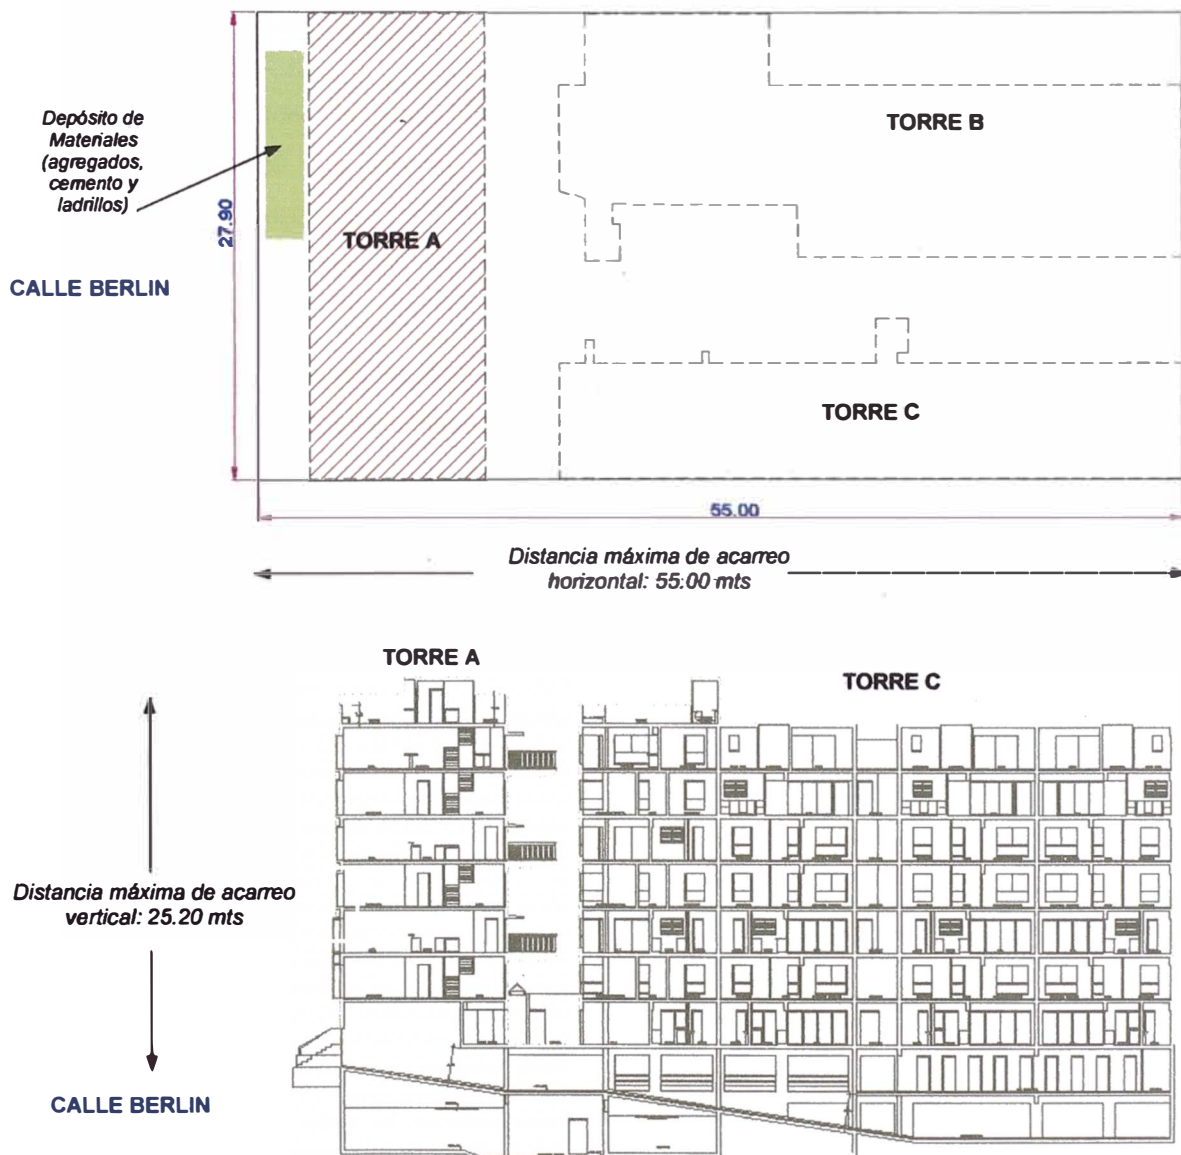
Emplazamiento y dimensiones del terreno del proyecto Berlin.
